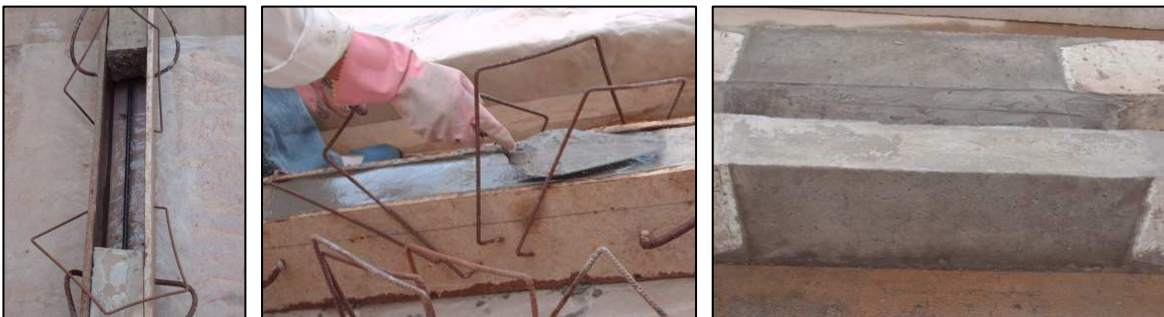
Viga encofrada, colocación del mortero y viga reparada
